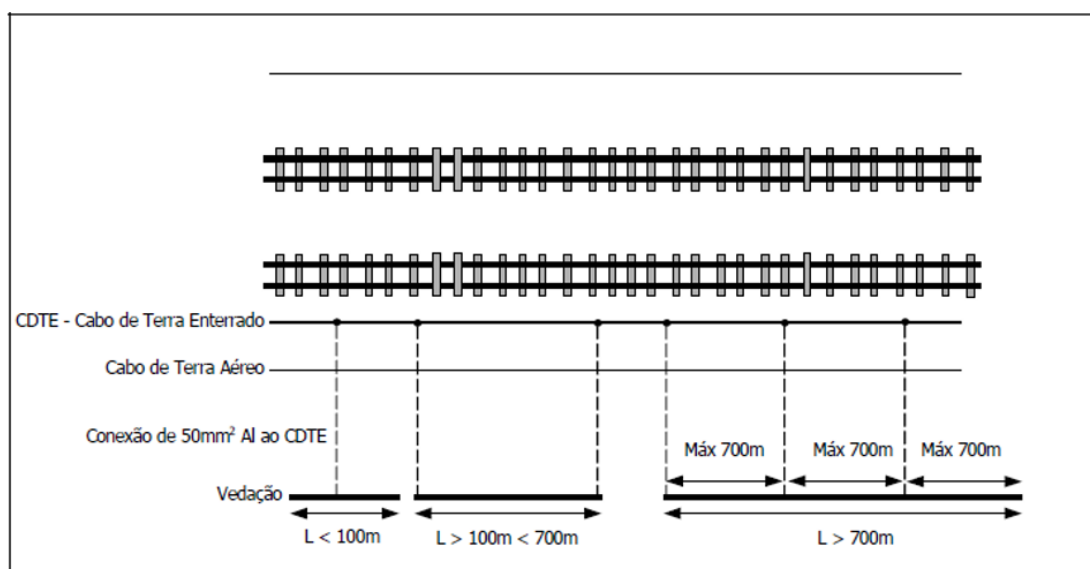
Ligação à terra de vedações paralelas à via dentro do GD + 10 m
